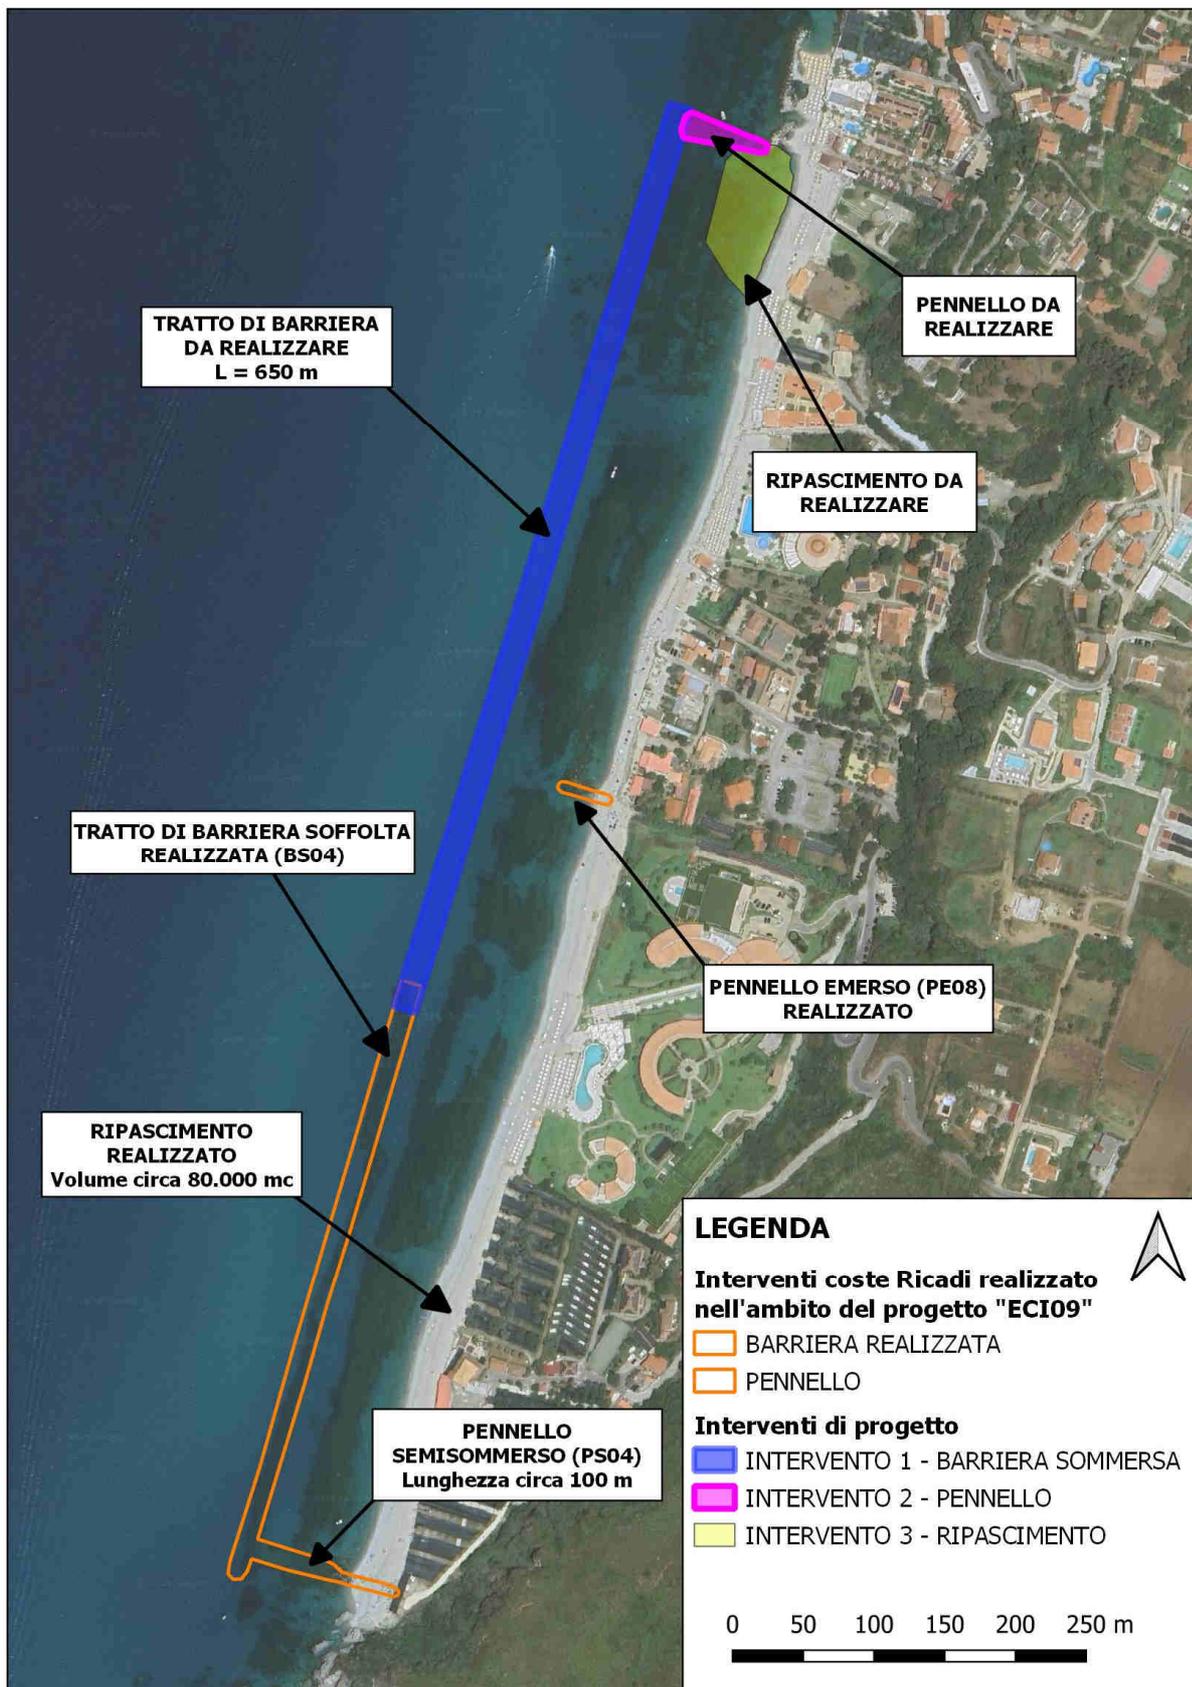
PLANIMETRIA GENERALE DEGLI INTERVENTI PREVISTI.
